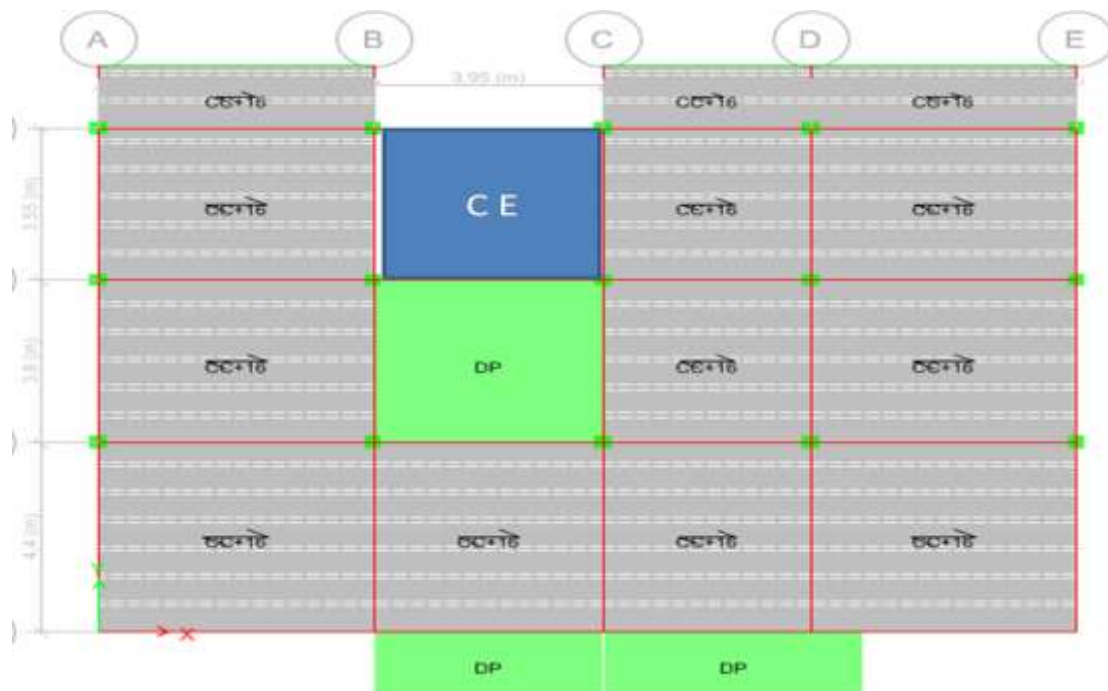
Plan de disposition des poutrelles (Etage 07)
